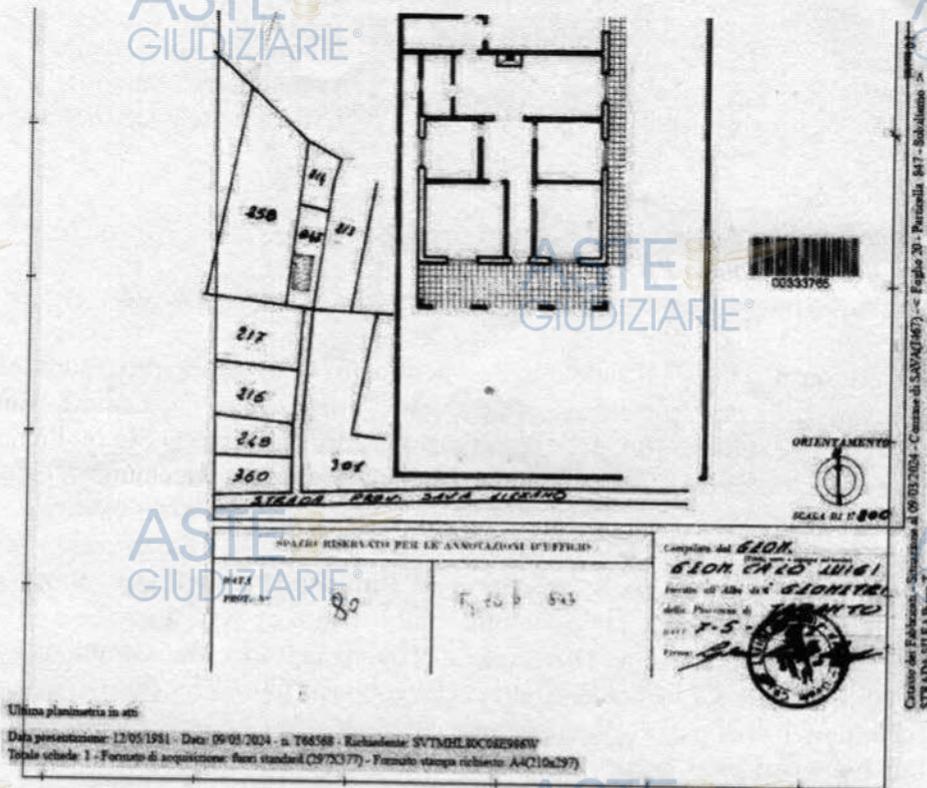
Planimetria catastale lotto unico, in NCEU Sava fig.20 p.lla847, con indicazione della strada di accesso, lato sud.
